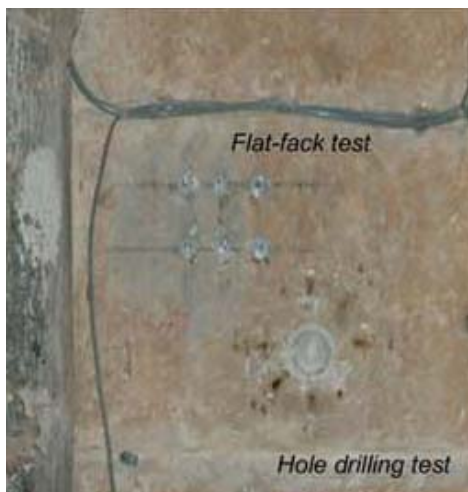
Ensayo de gato plano simple en el Pilar 2 de la Colegiata de Toro (Fuente ONSITEFORMASONRY).
